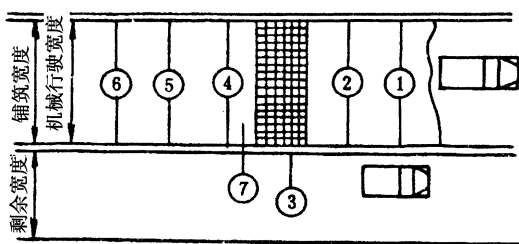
滑模式摊铺机施工时的施工机械组合
